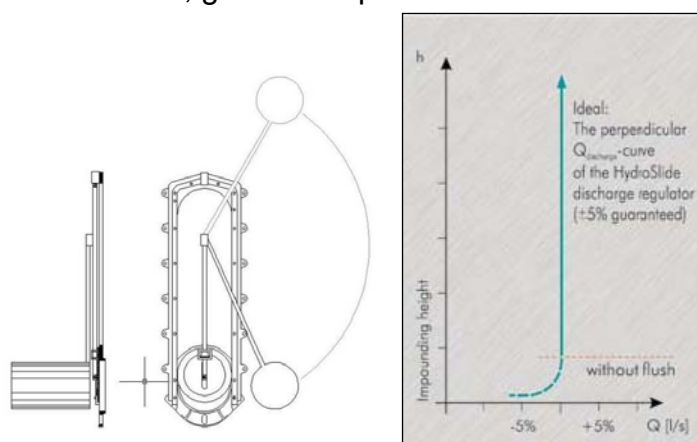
Dispositivo di regolazione delle portate tipo "Hydroslide": particolare costruttivo e principio di funzionamento
